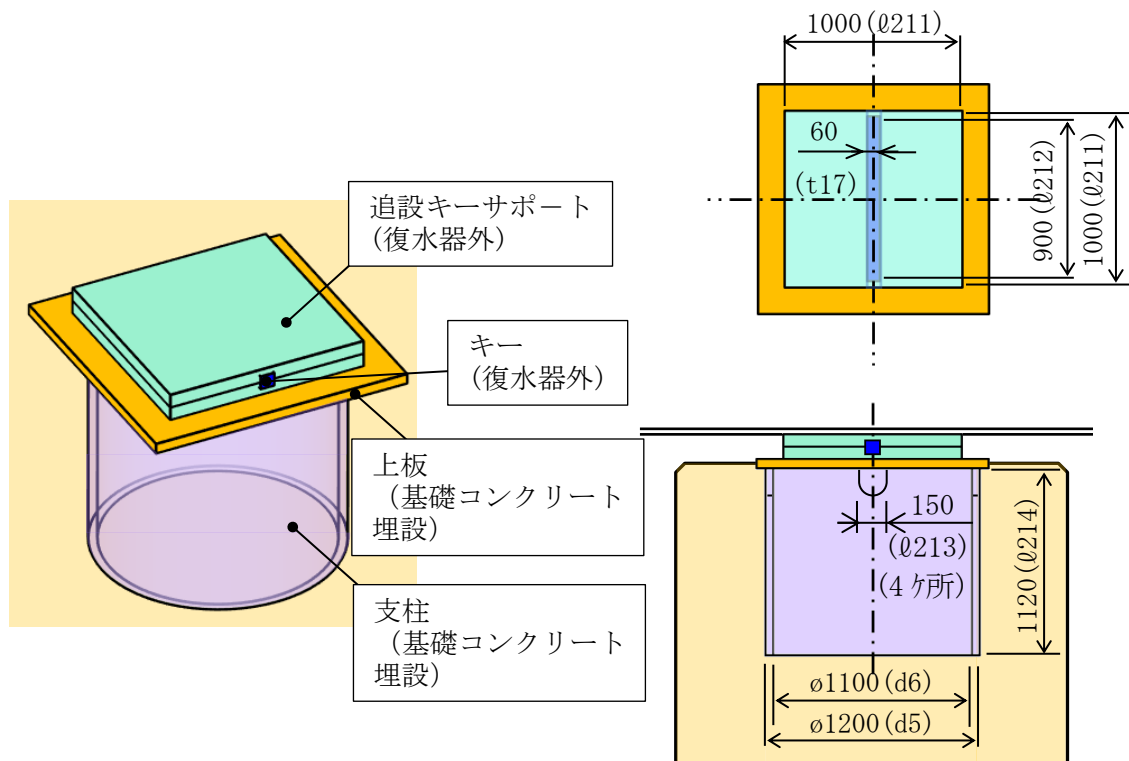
No. ⑩⑪追設キーサポート鳥瞰図, 平面図, 断面図
